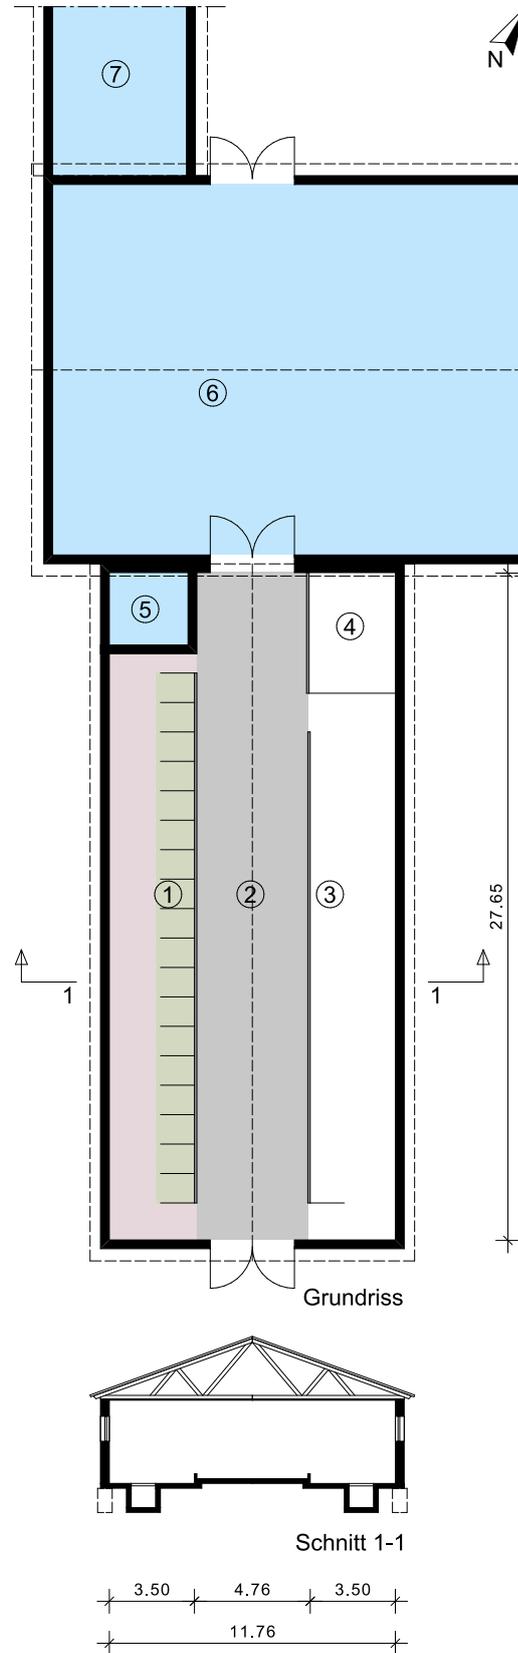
Bauzeichnung Altgebäude Betrieb E
